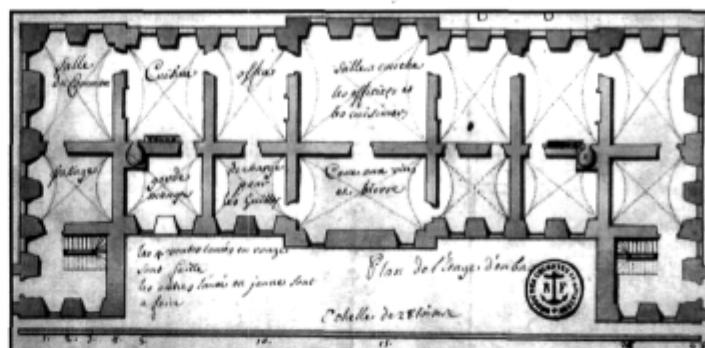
Rez-de-chaussée du Palais en 1715. Extrait. Centre des archives d'outre-mer (France), 03DFC 391C
